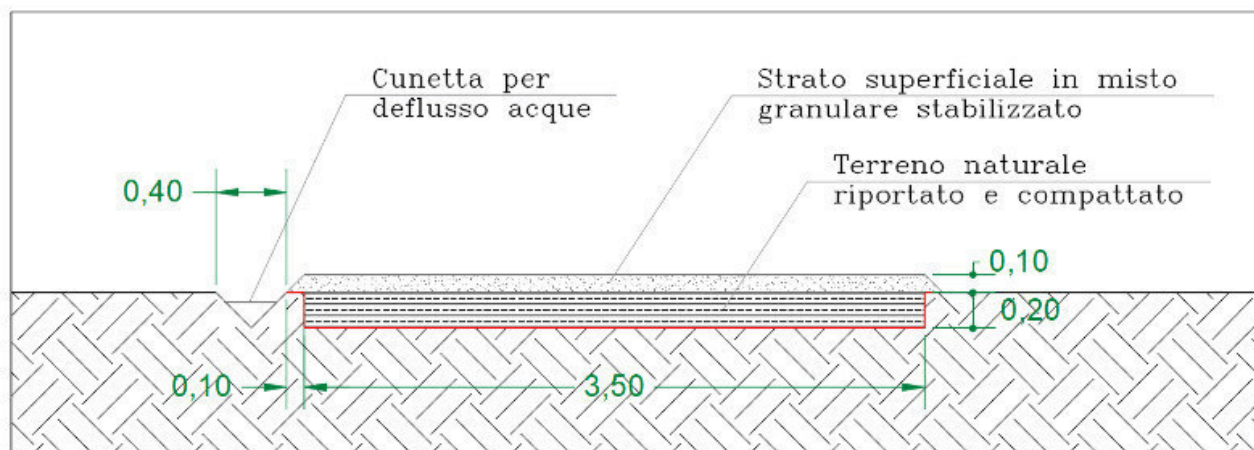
Sezione trasversale strada con indicazione della cunetta
